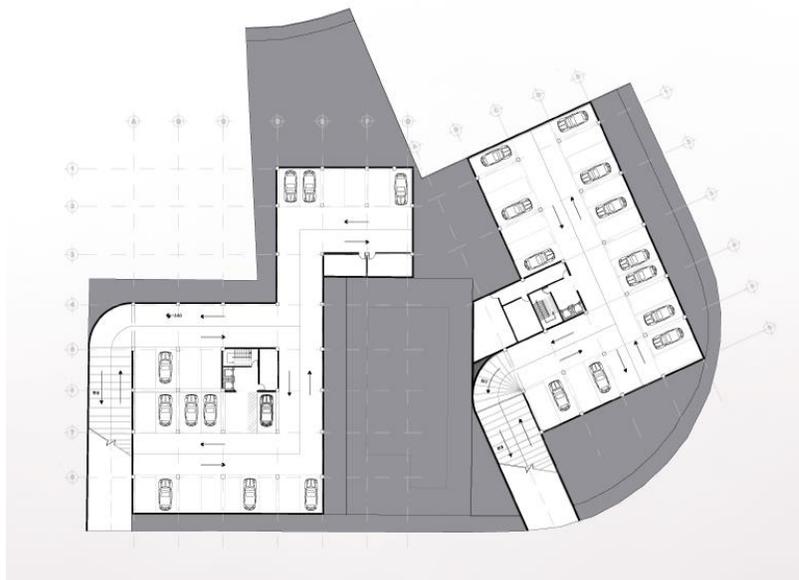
Planimetría: Planta subsuelo (N -3.60)
